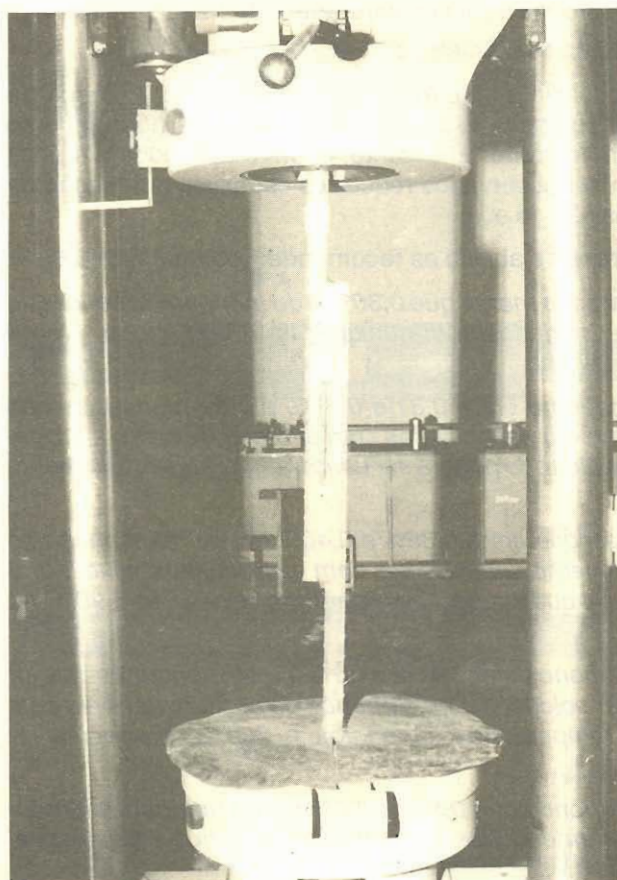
Emenda por sobreposição com solda de deposição de eletrodos em cordões afastados - Itaipu
